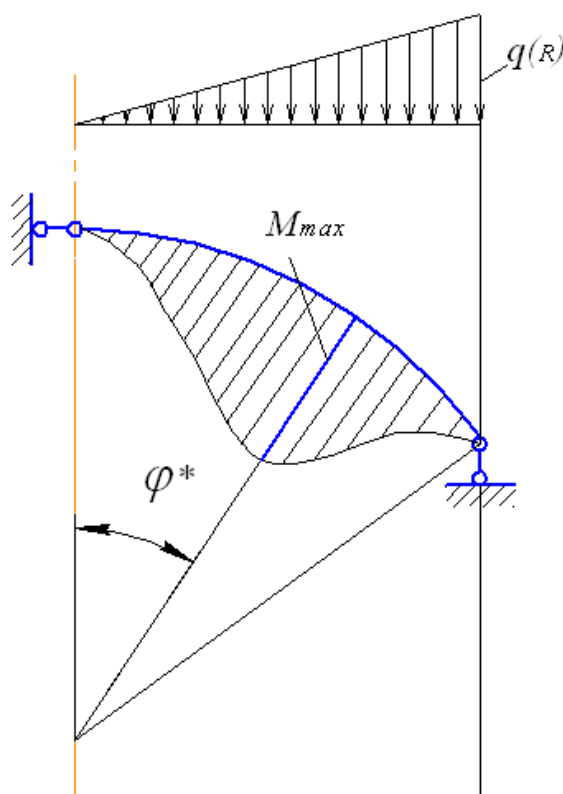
Эпюра изгибающего момента в поперечных сечениях главной балки.
